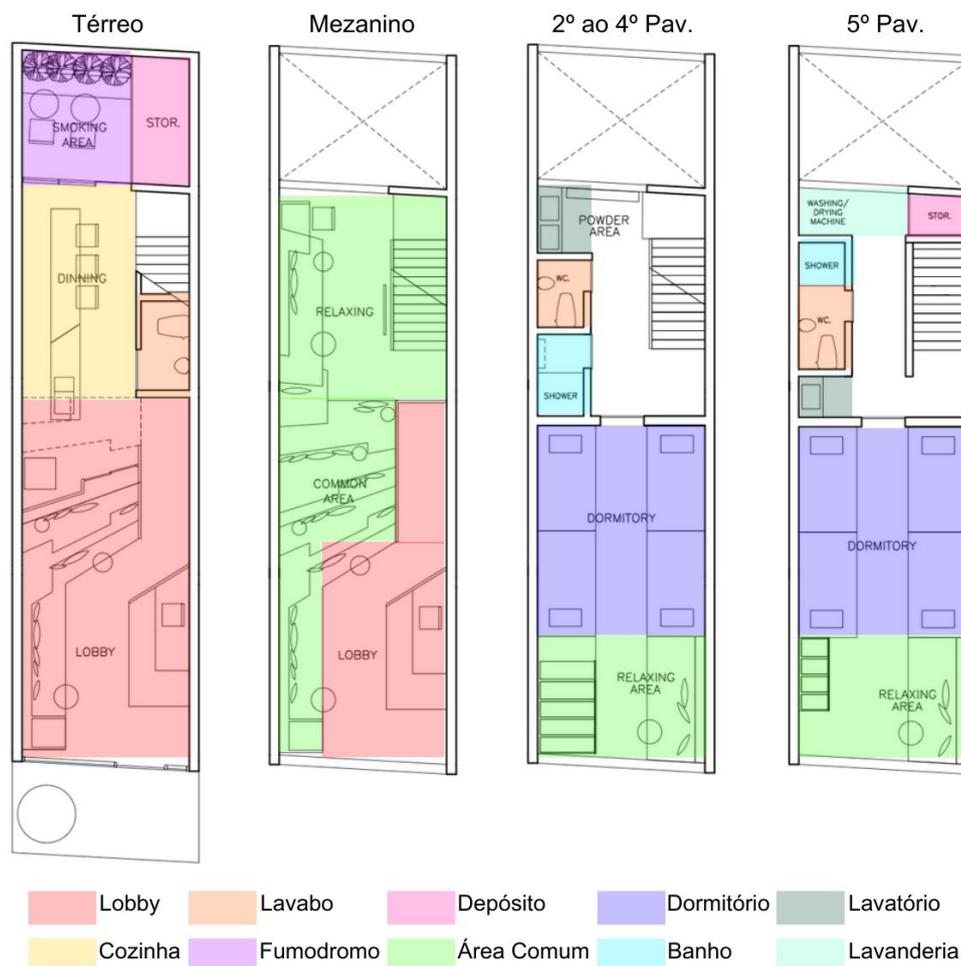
Setorização / Planta baixa. Alterado pelo autor.
